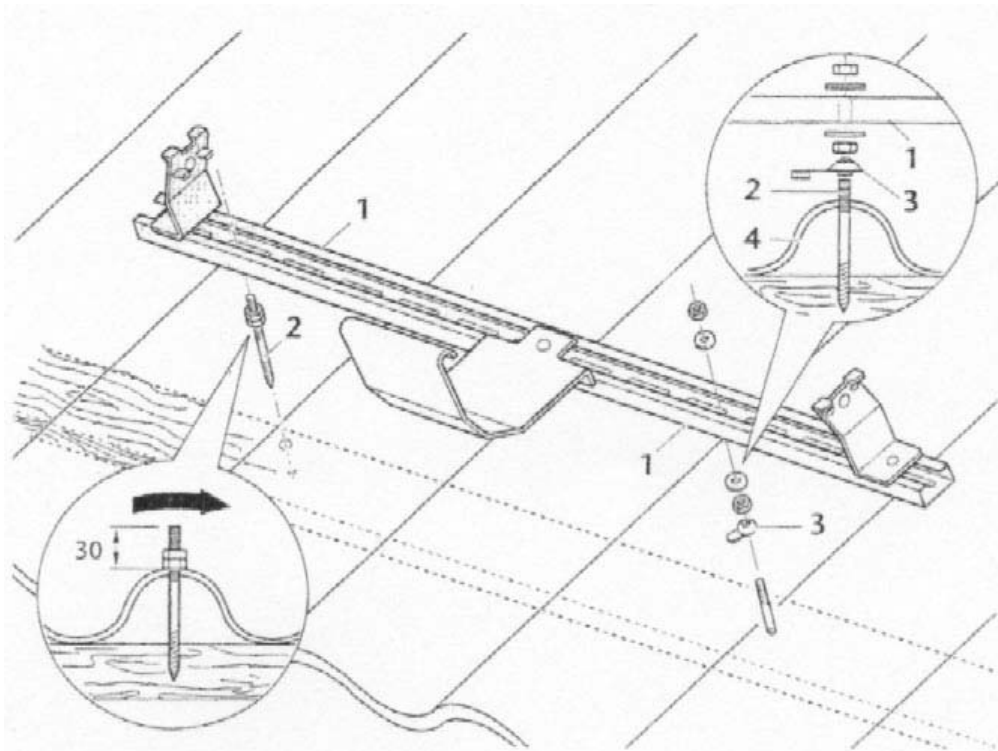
Montage sur toiture inclinée du capteur LOGASOL SKN, détail de montage en plaques ondulées
